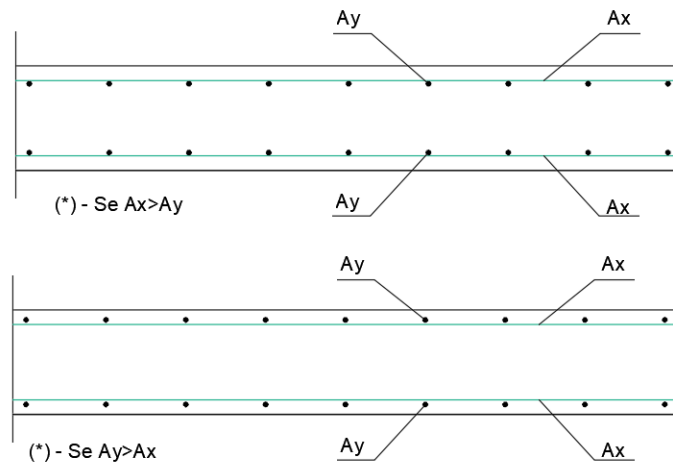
Pormenor de distribuição de armadura em lajes maciças (Projeto de estruturas).
